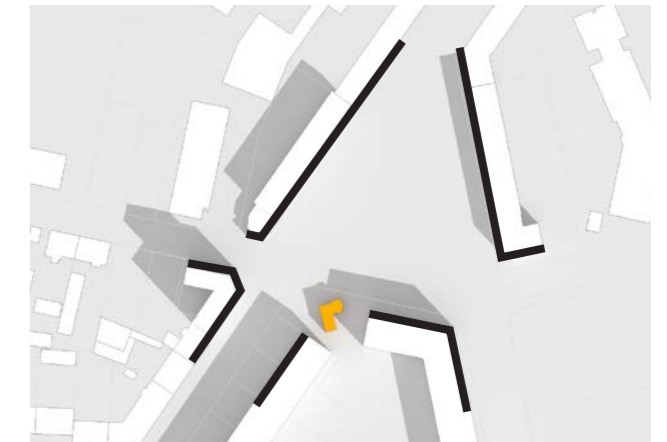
Vorzugsvariante - Umgang mit dem Pfortnerhaus
